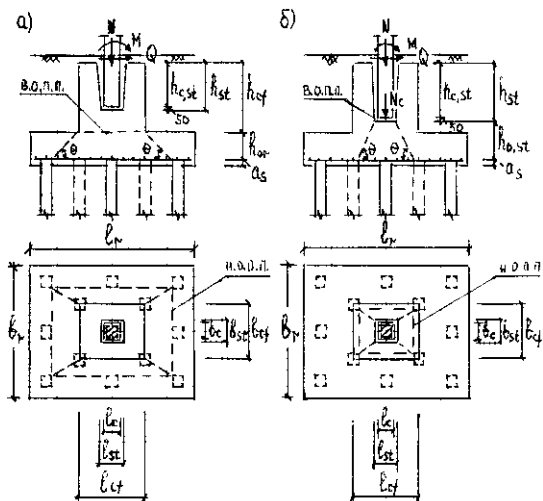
Схемы образования пирамиды продавливания ростверка при стаканном сопряжении сборной железобетонной колонны с высоким (а) и низким (б) подколонником
